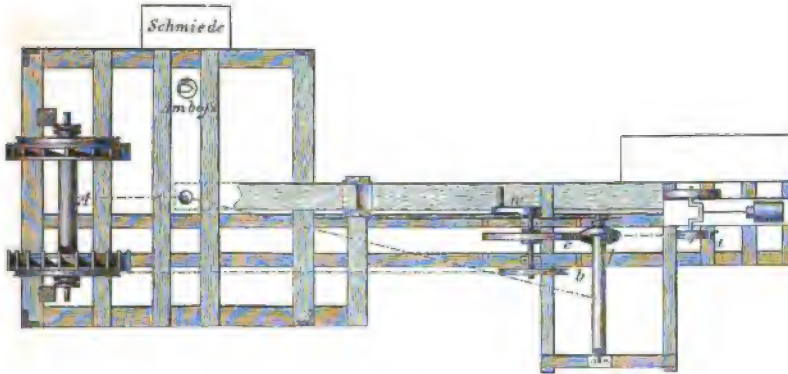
(Grundriß). Einrichtung beim amerikanischen Seilbohren.
